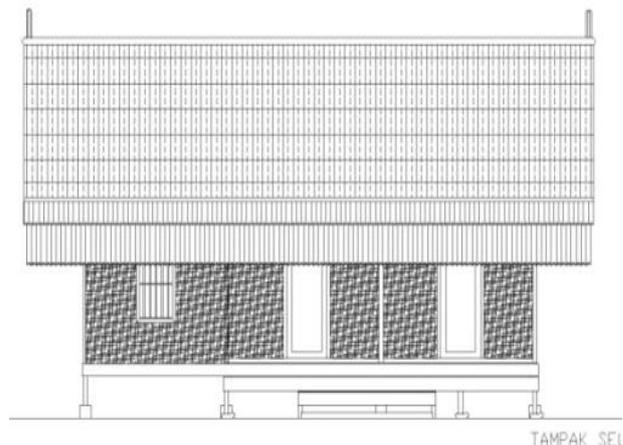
Tampak depan bangunan tradisional di Kampung Pulo
